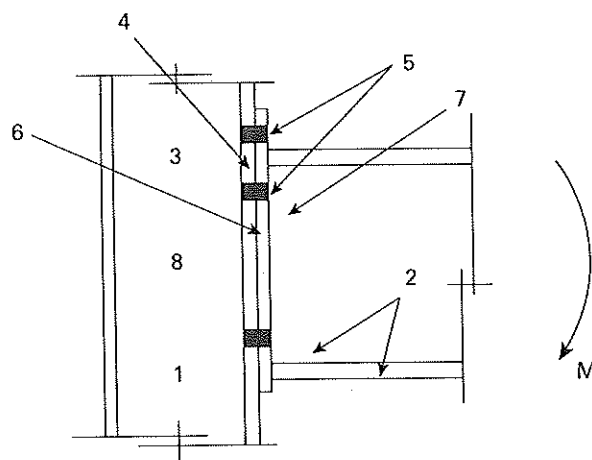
Les composantes d'un assemblage poutre-poteau « traditionnel »
